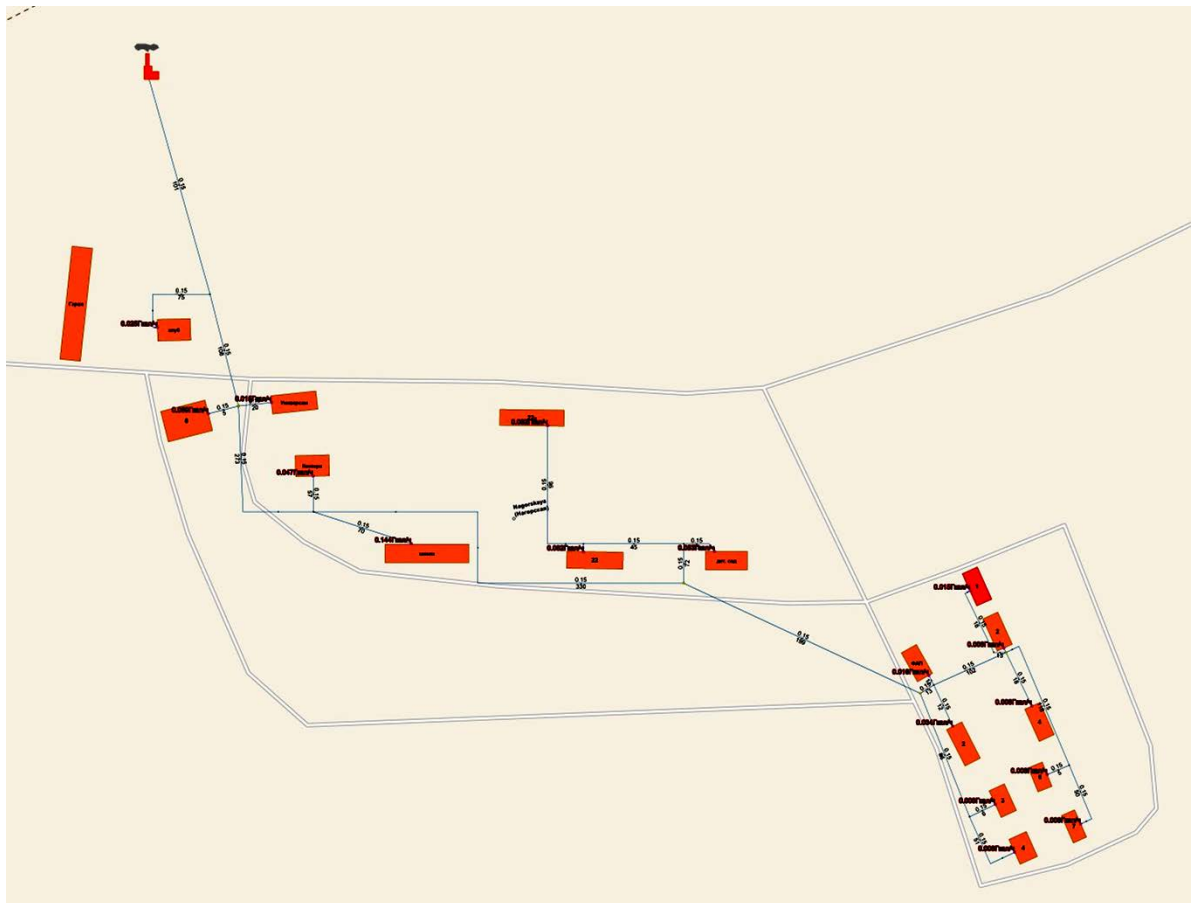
Тепловые сети и тепловые нагрузки на расчетный период
